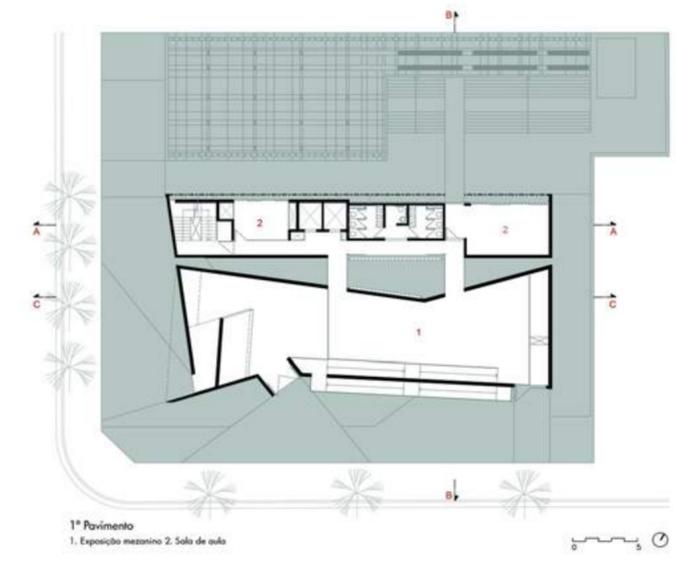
Planta Primeiro Pavimento. Fonte: Archdaily
